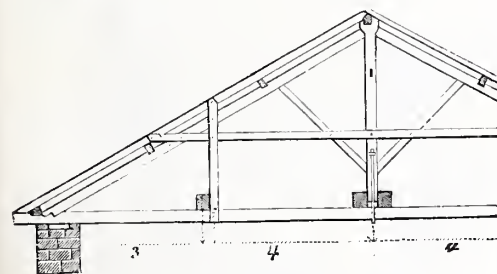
Dach mit dreisäuligem Hängewerk.
